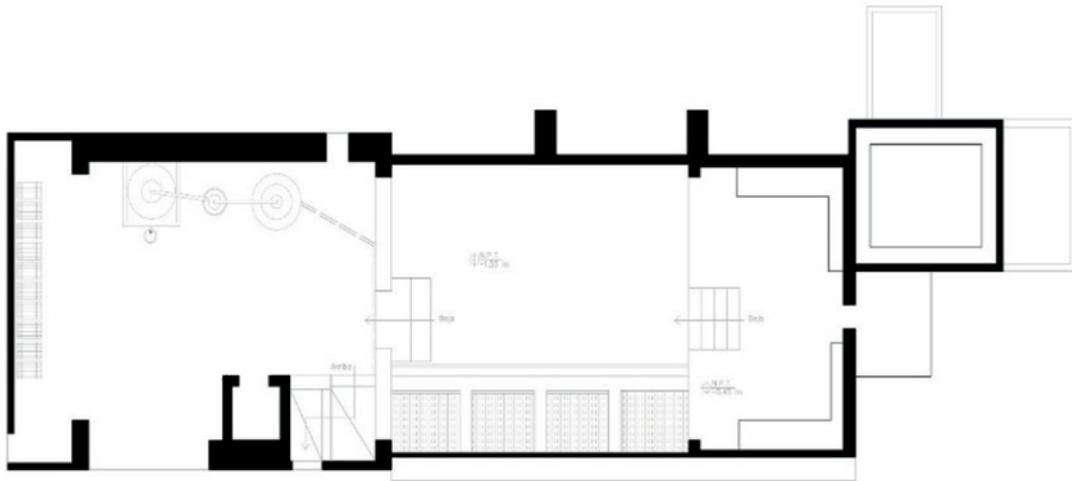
Planta arquitectónica donde se muestra la distribución de cada elemento que conforma la fermentación y destilación del mezcal. Fuente: elaboración propia.
